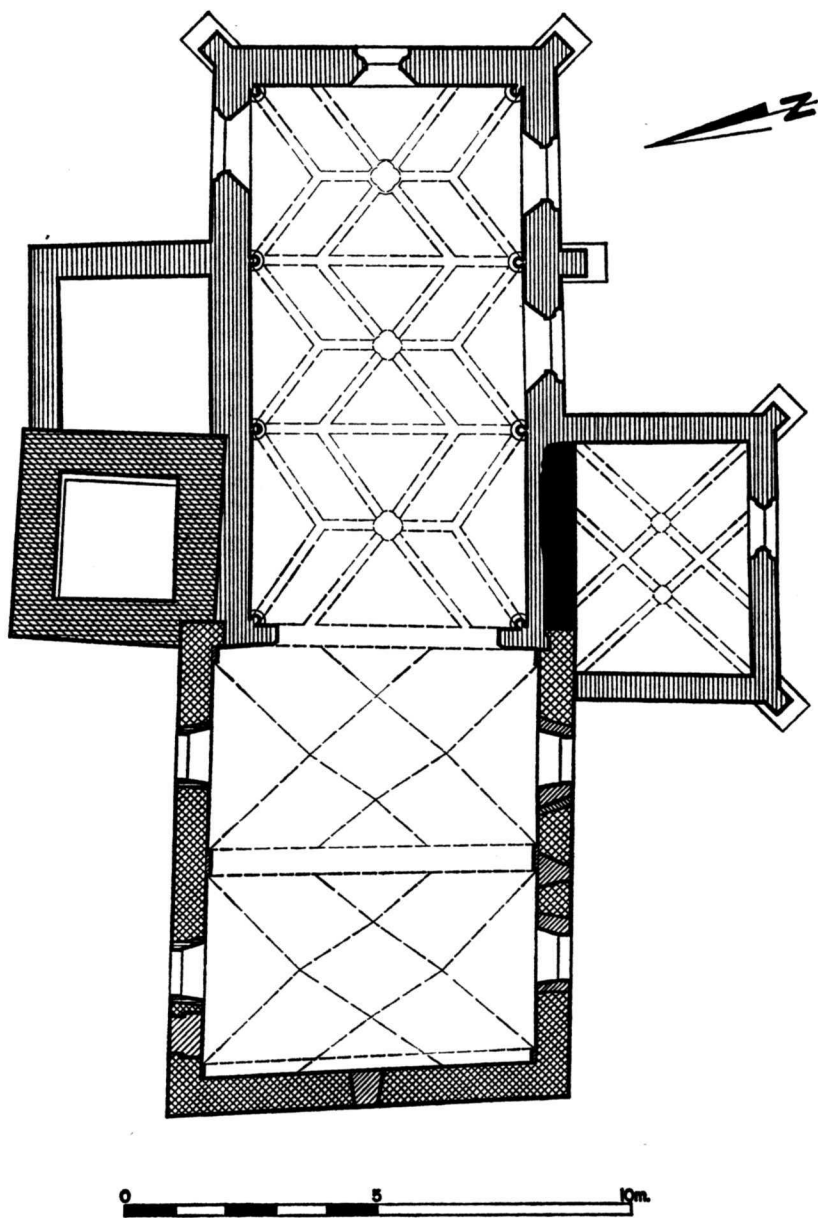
Plan au niveau III (fenêtres et voûtes ;
